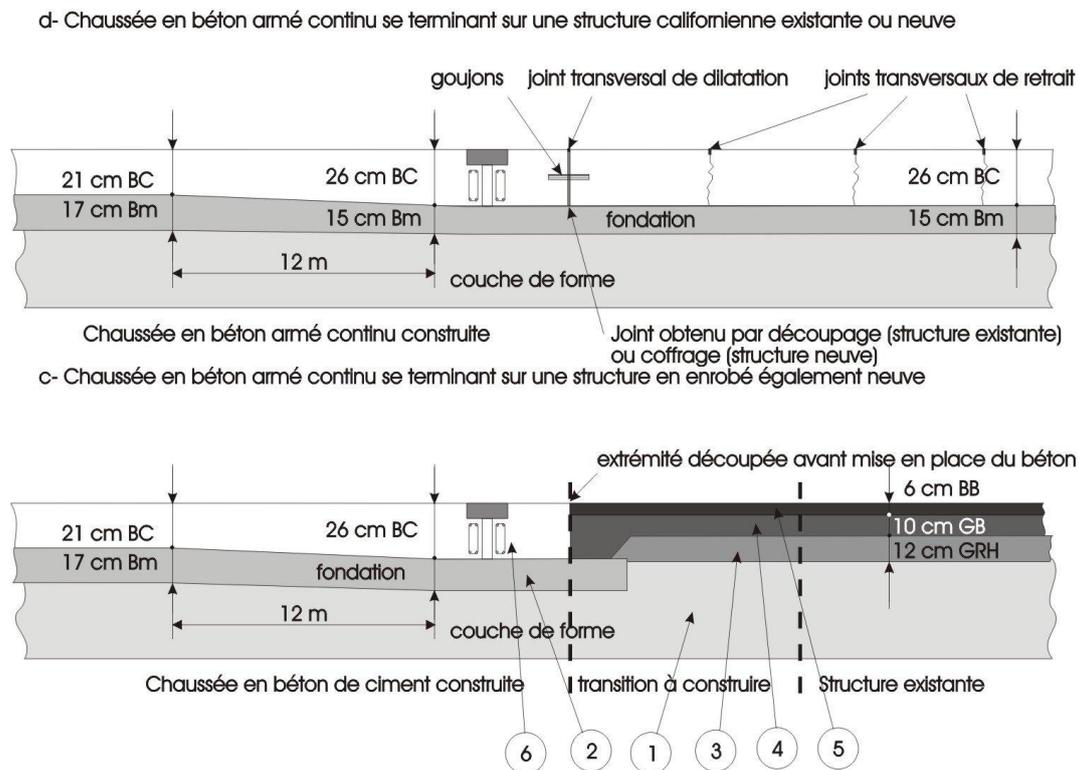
Exemple de deux extrémités de revêtement en BAC: en haut se raccordant sur un revêtement en béton à dalles, et en bas, sur un revêtement en matériaux bitumineux
